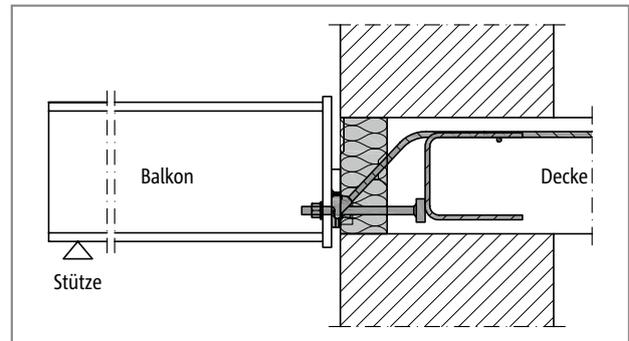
Schöck Isokorb® T Typ SQ: Anschluss an die Stahlbetondecke; monolithische Konstruktion der Wand
